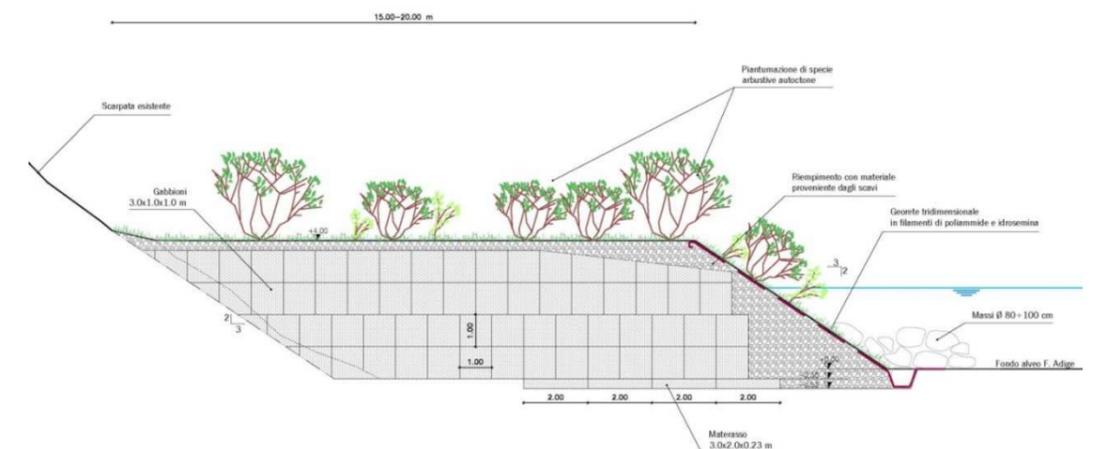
Pennello fluviale: sezione trasversale tipo.
